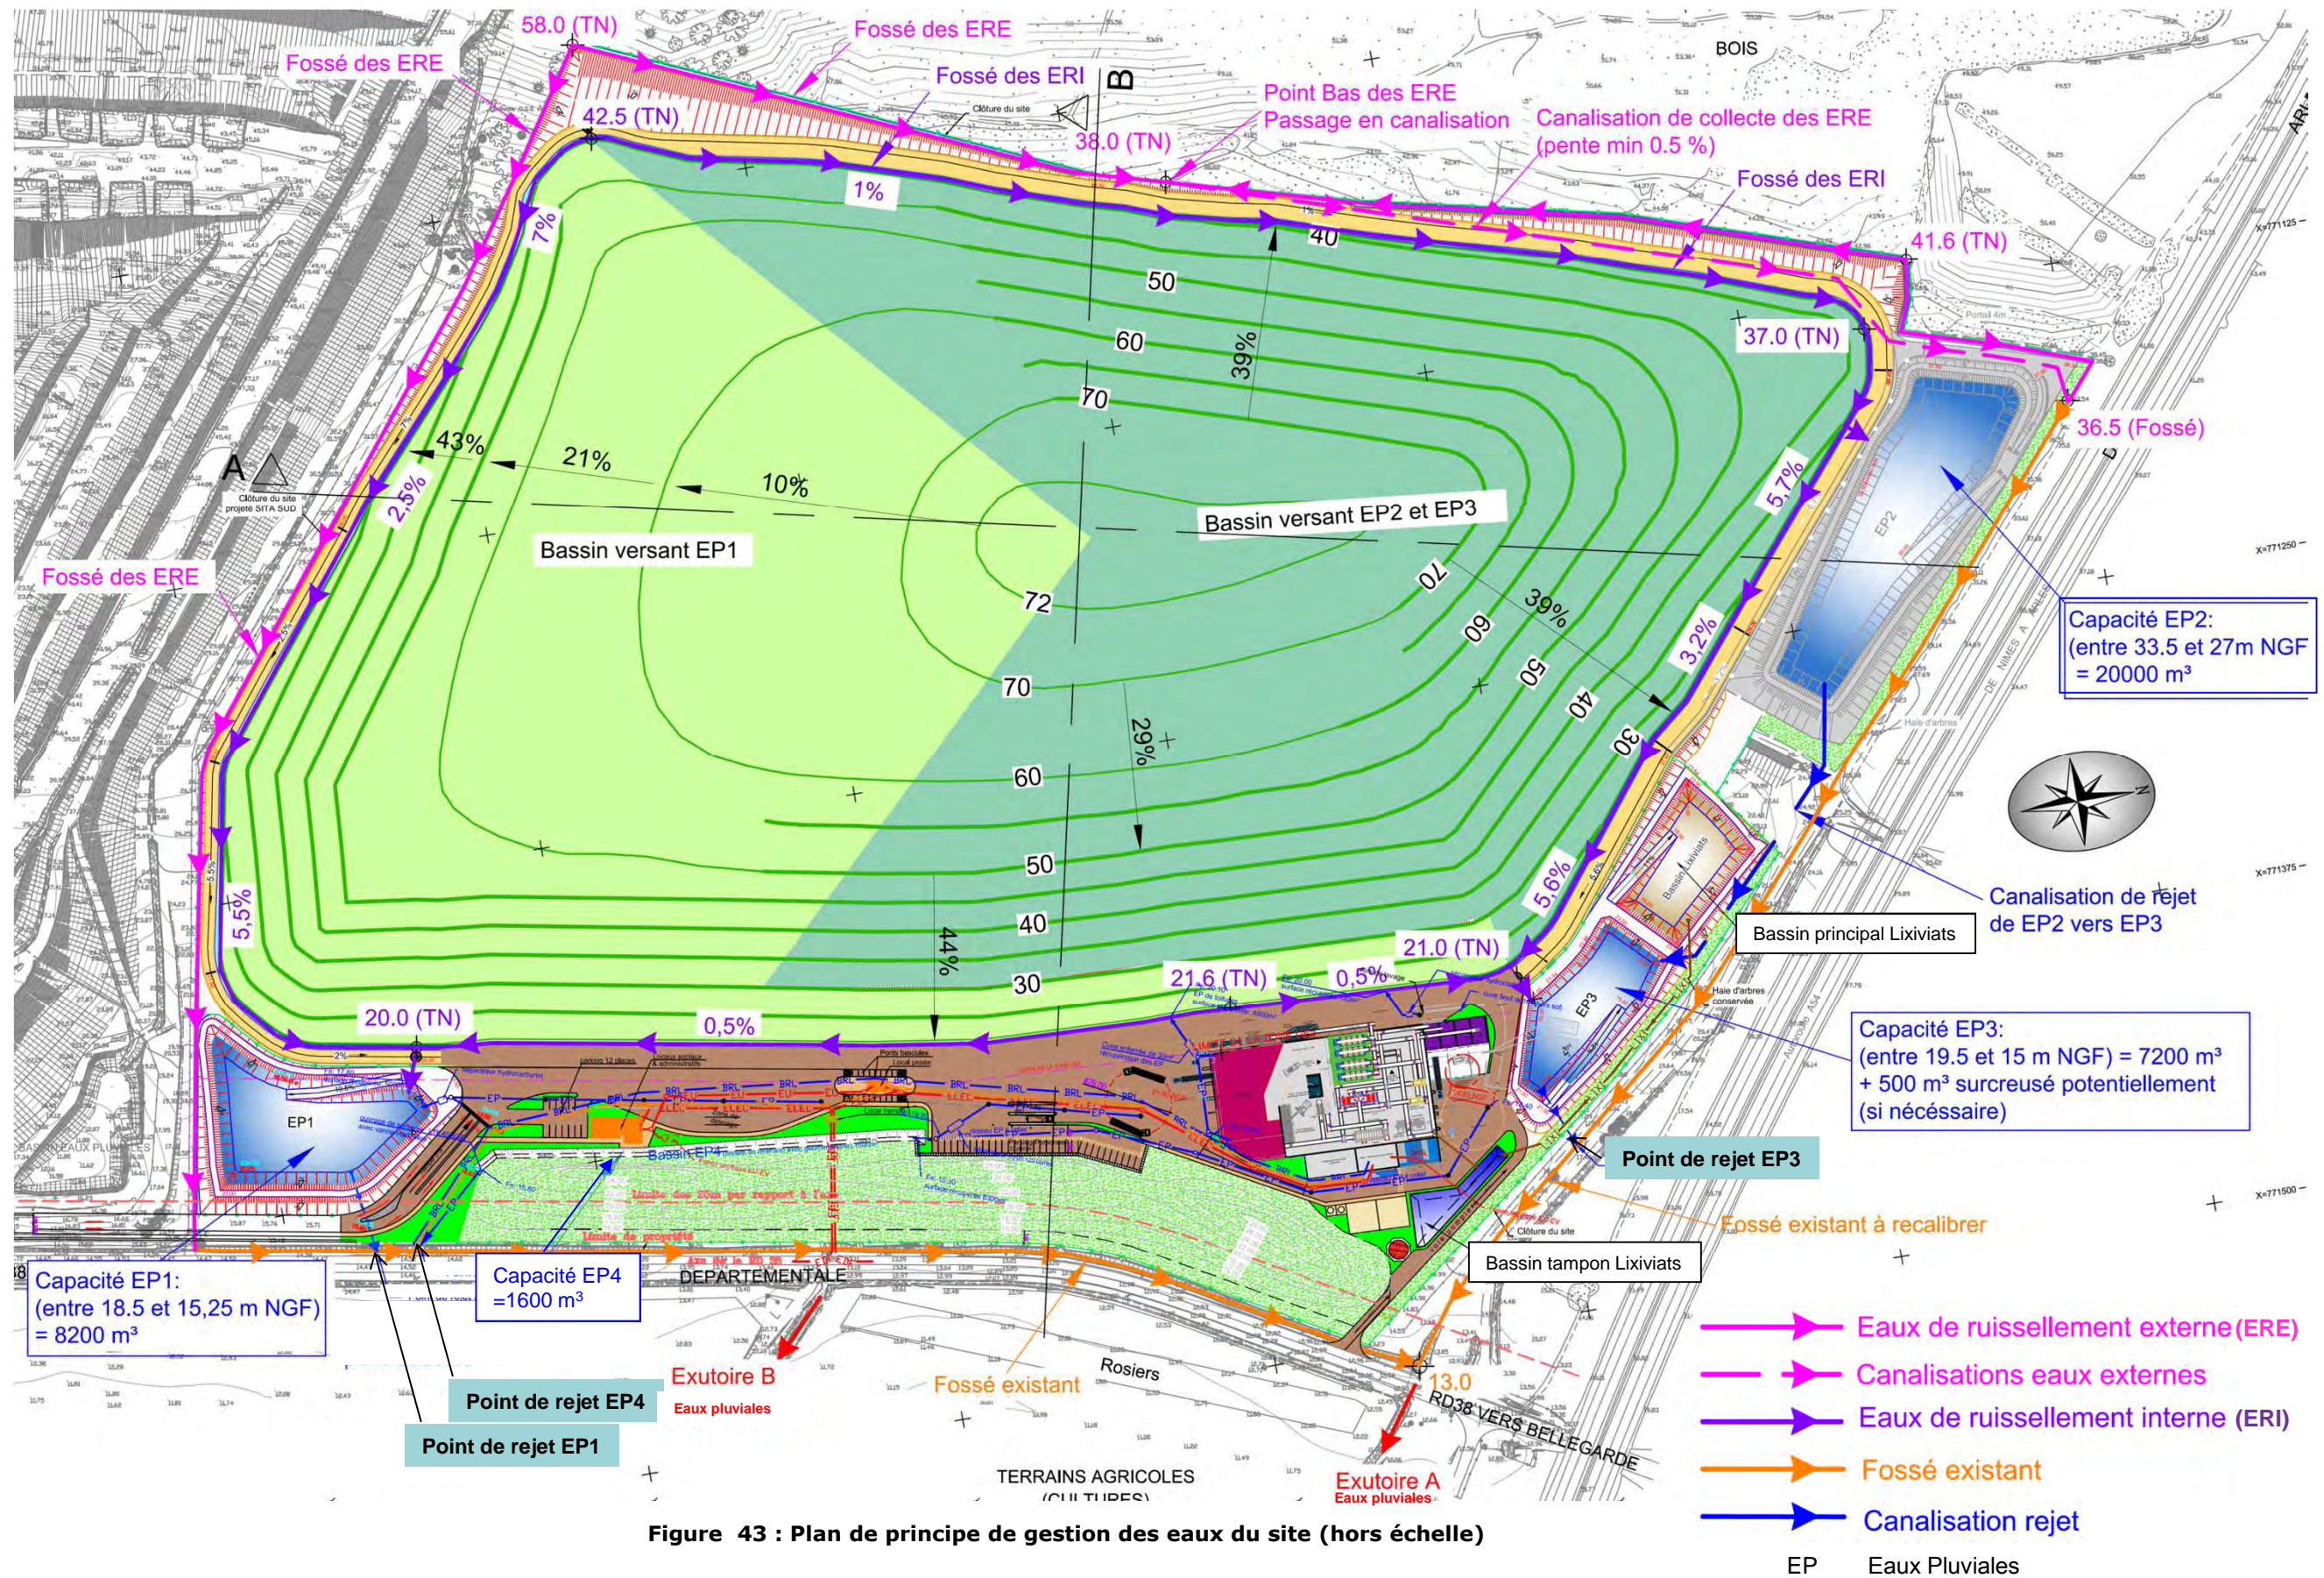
Plan de principe de gestion des eaux du site (hors échelle)
